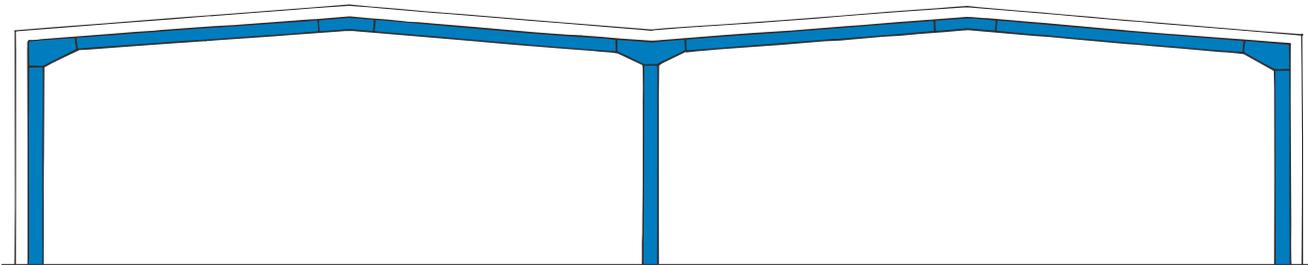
Dreistieliger Rahmen aus Vollwandprofilen mit gelenkigen Fußpunkten, Industriehalle, Spannweite 17,00 m
